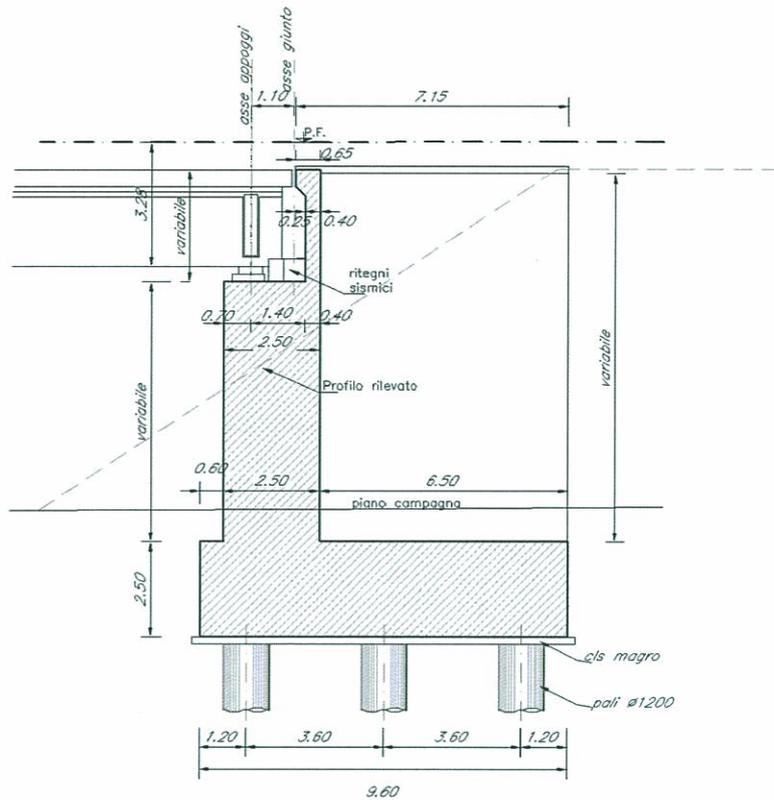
Sezione longitudinale della spalla tipo.
